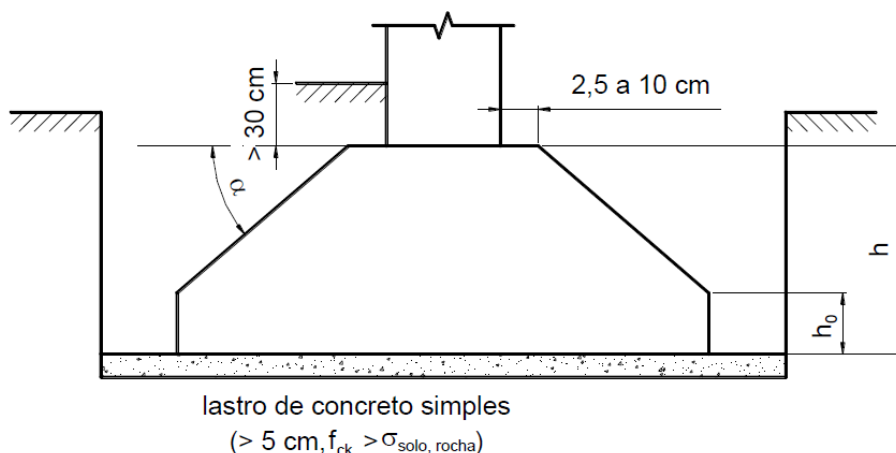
Detalhes construtivos para sapata (Bastos, 2016)
